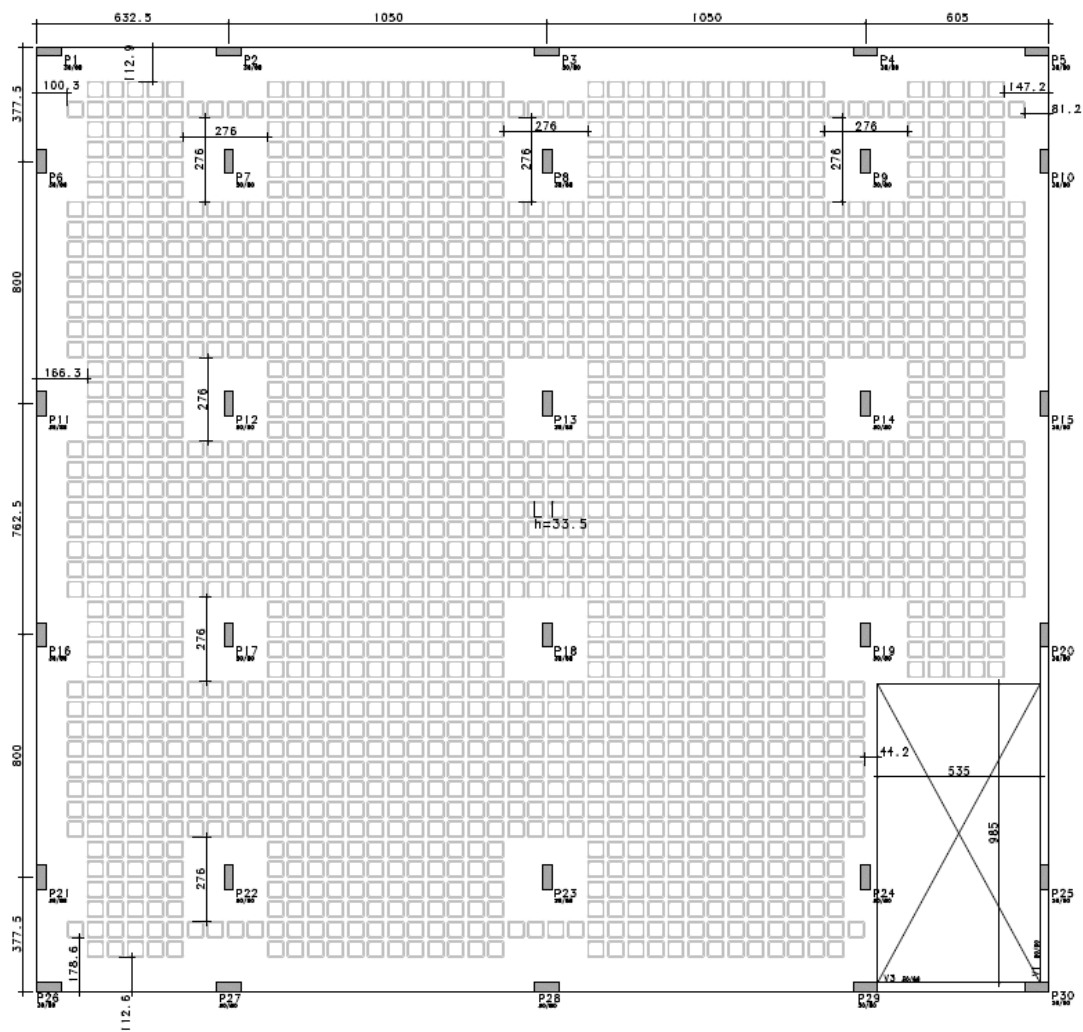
Projeto B2 – Planta de forma (dimensões em cm).
